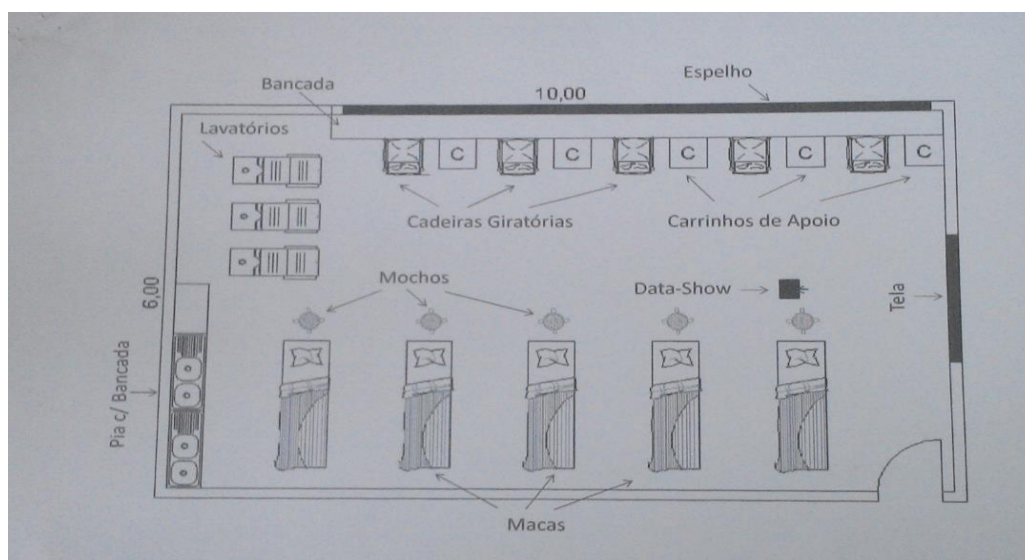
Layout do laboratório para aulas práticas de estética e embelezamento
